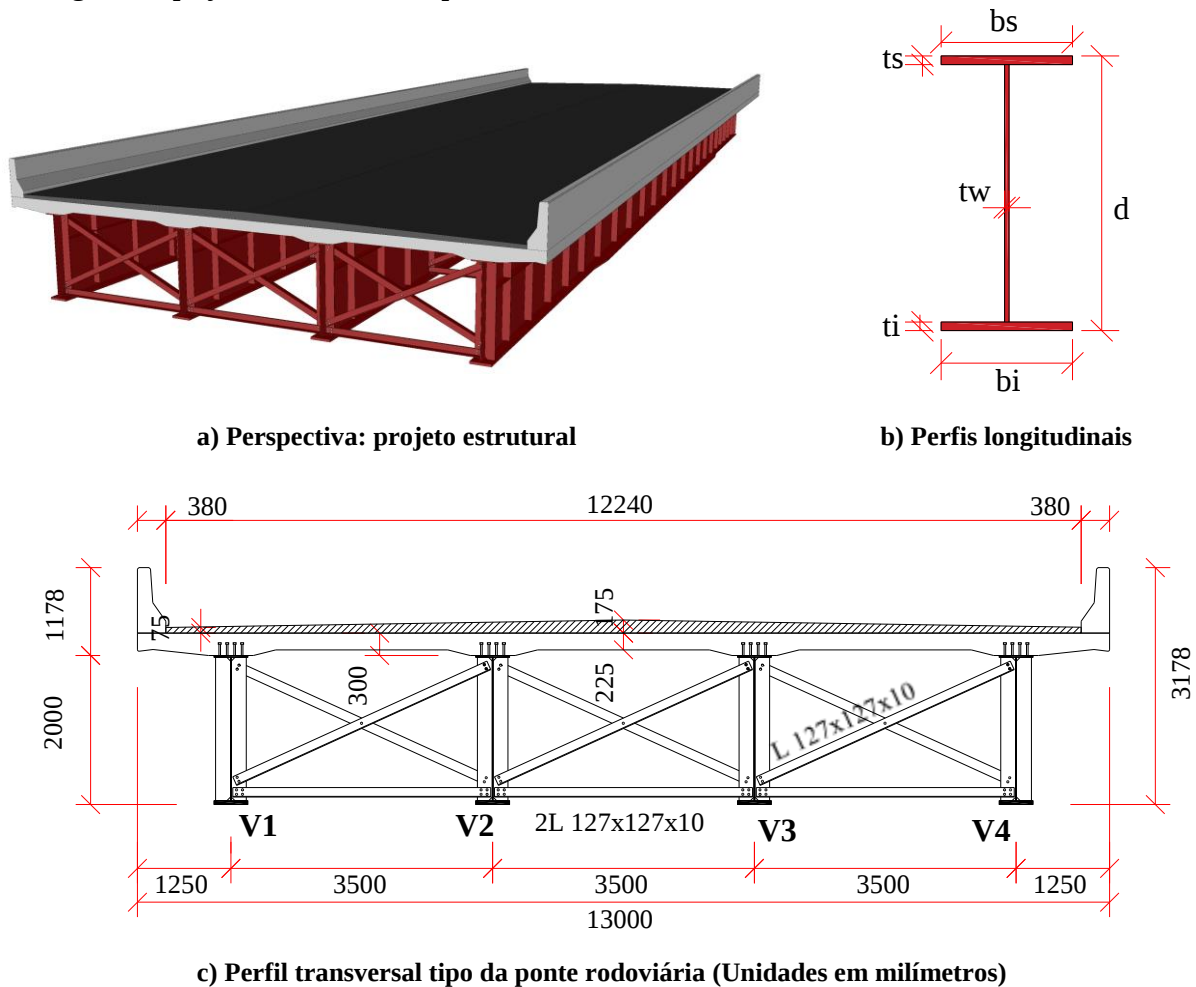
Projeto estrutural da ponte rodoviária mista (aço-concreto)
